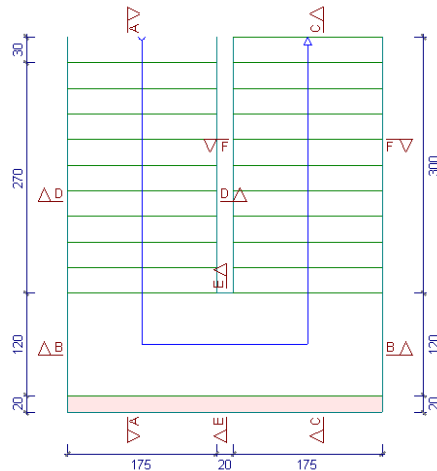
Geometría de la escalera planta baja sección administrativa.
